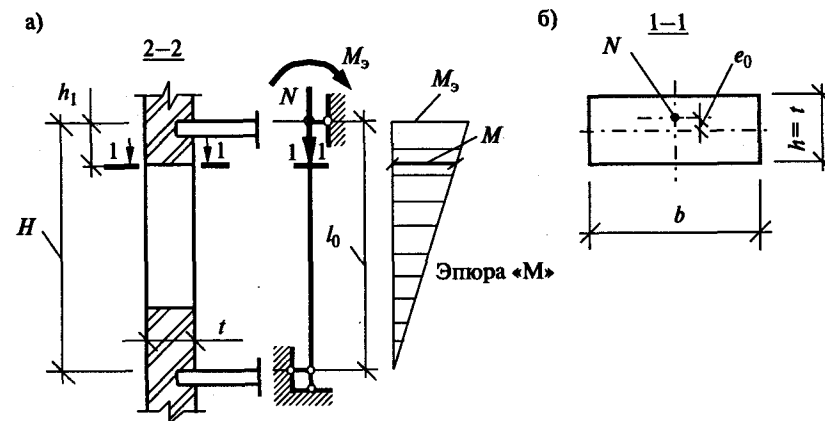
К расчету простенка: а) разрез стены и расчетная схема; б) расчетное сечение простенка;  $M_s$  — изгибающий момент, действующий на простенок от перекрытия, расположенного непосредственно над сечением простенка
